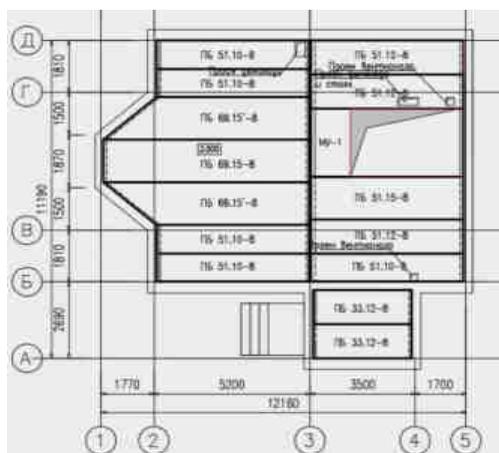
План сборного перекрытия из ж/б пустотных плит
